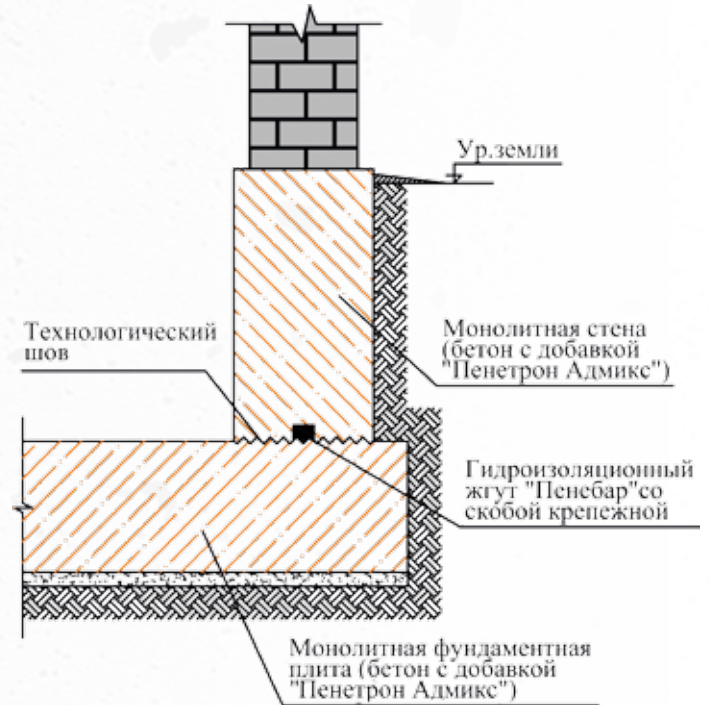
Гидроизоляция фундамента на стадии возведения
